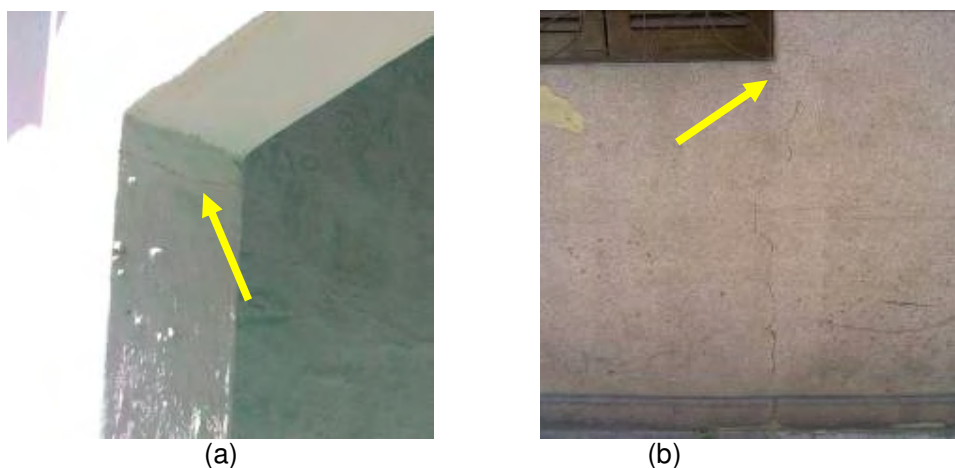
Fissuras em encontros: (a) de alvenarias; (b) de janela.
